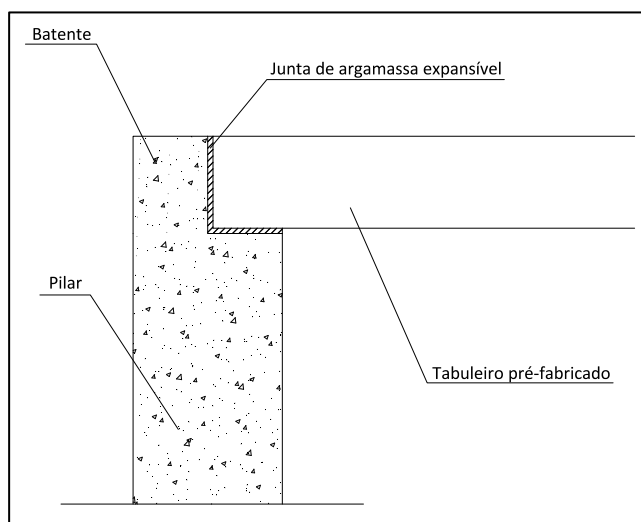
Pormenor da ligação tabuleiro-pilar de canto
